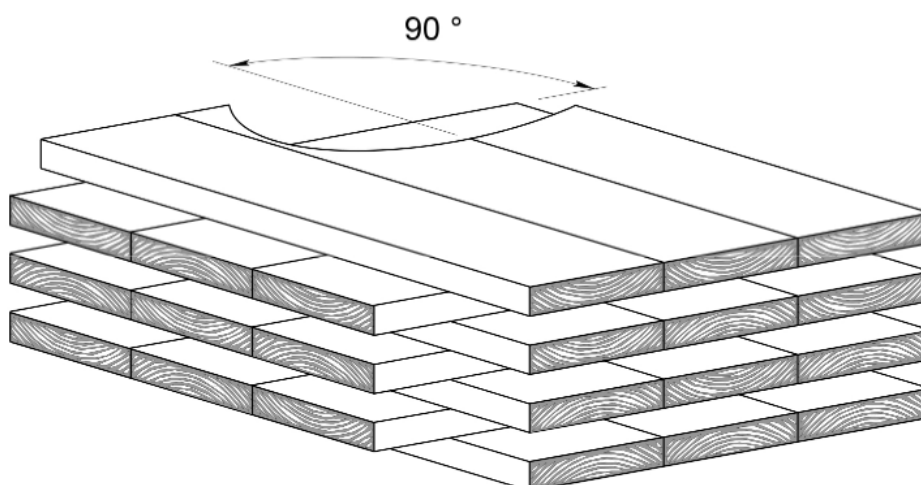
Принципиальная схема плитной конструкции из ДПК
